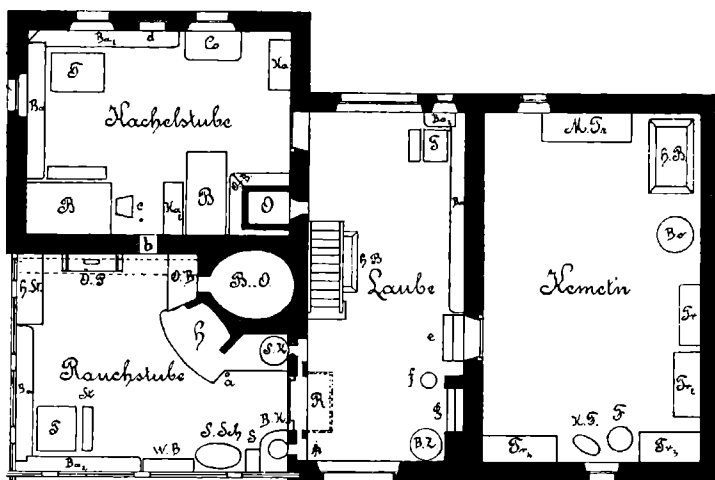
Grundriss des Erdgeschosses des Winkler-Hauses.
